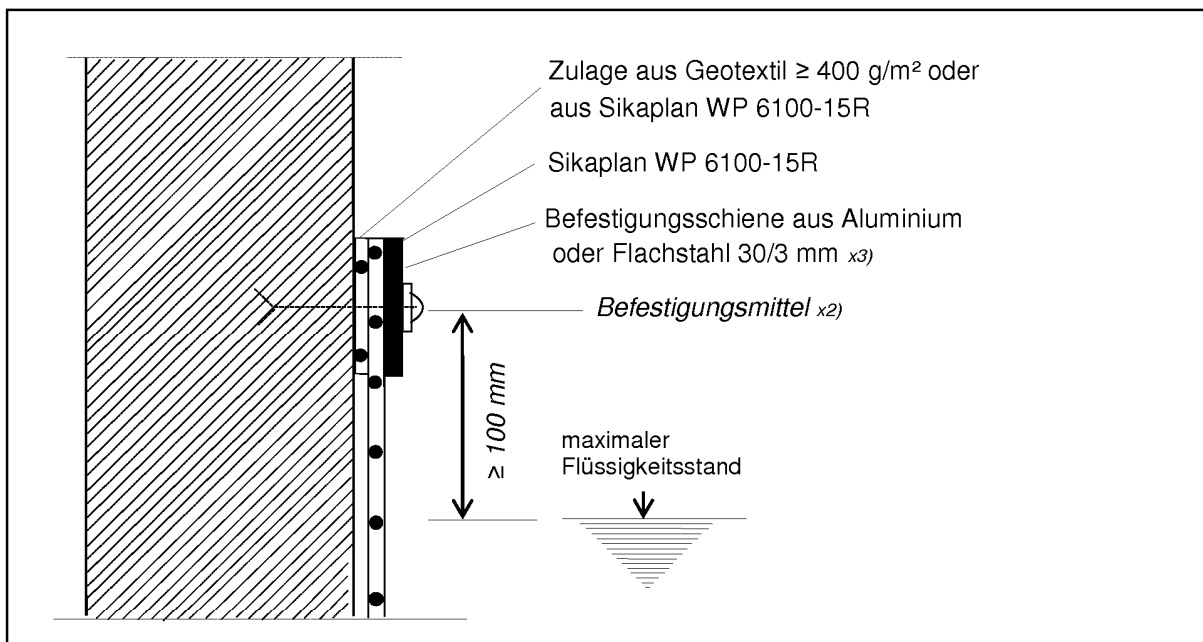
Randverwahrung mit Klemmschiene (Detail A)
